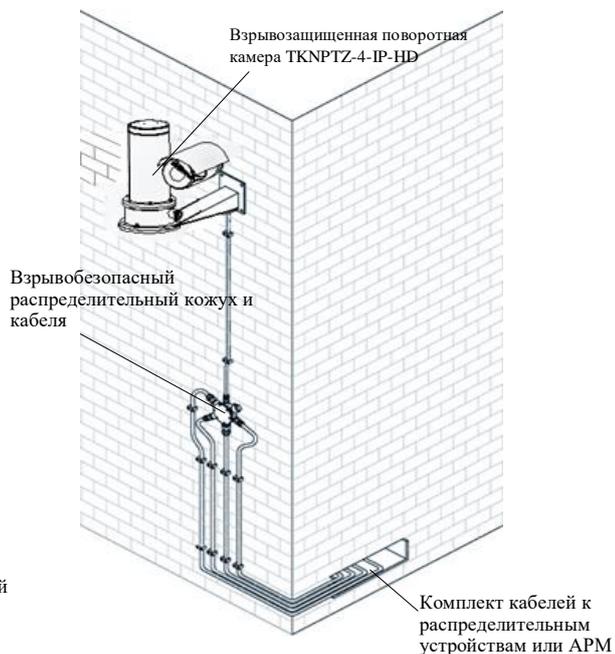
Монтаж камеры и подсоединение кабелей
